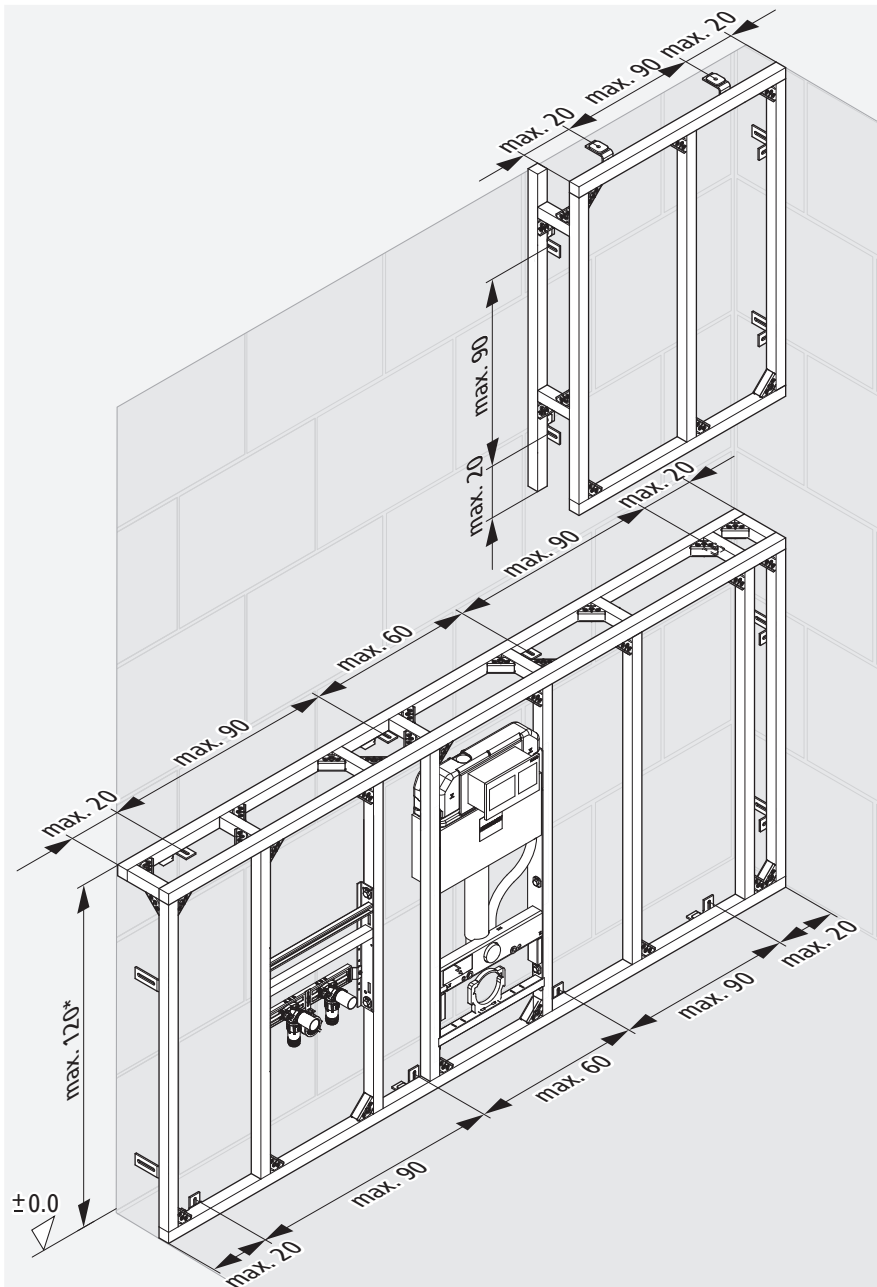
Dimensions de montage cadre de montage à hauteur du local avec surface de rangement
